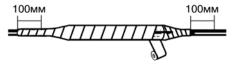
Обмотка корпуса прямой муфты лентой ВМ.
